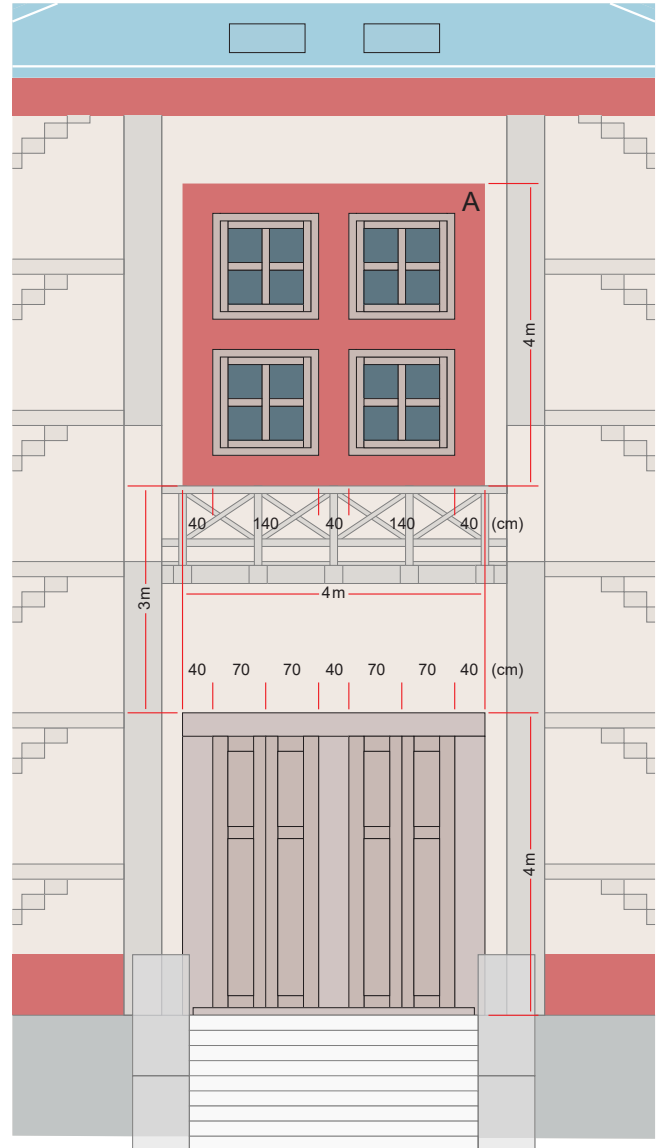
Meikirch. Rekonstruktion der Villa, Phase 2: Hallenhaus mit Annex. Detail der Südfassade mit grosser Tür und zentralem Hauptfenster. M. 1:100 und 1:20.
